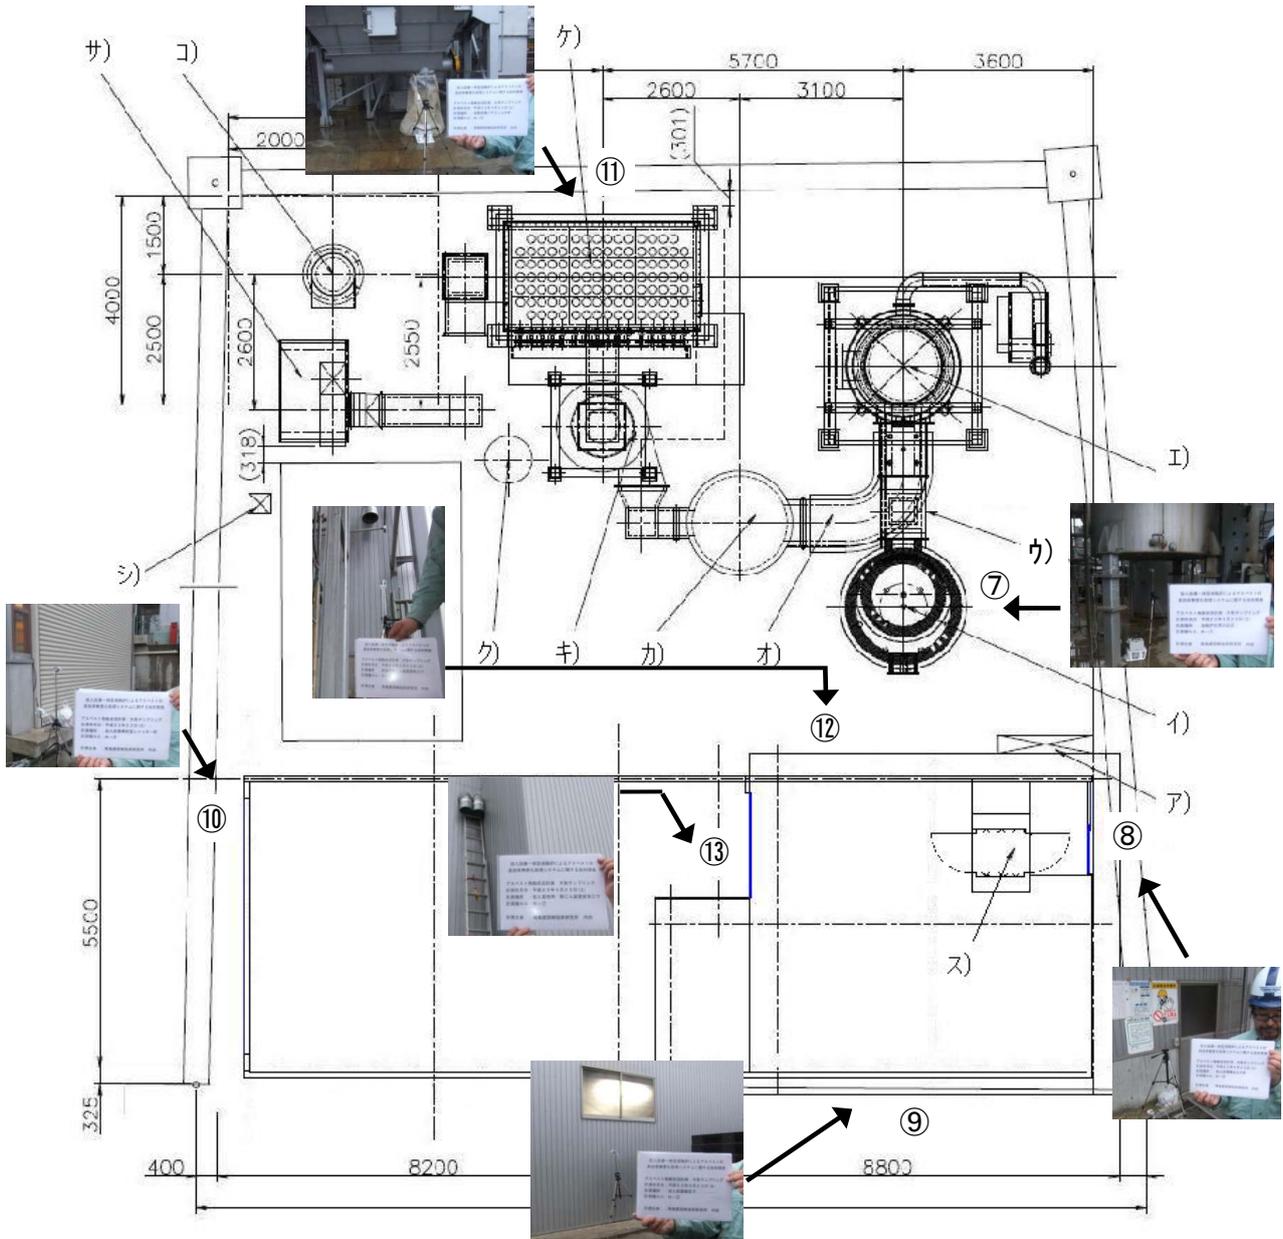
試験プラント近傍での石綿繊維飛散計測位置 (⑦~⑫ : GL+1.2m、⑬ : 屋根上 排気口下)
